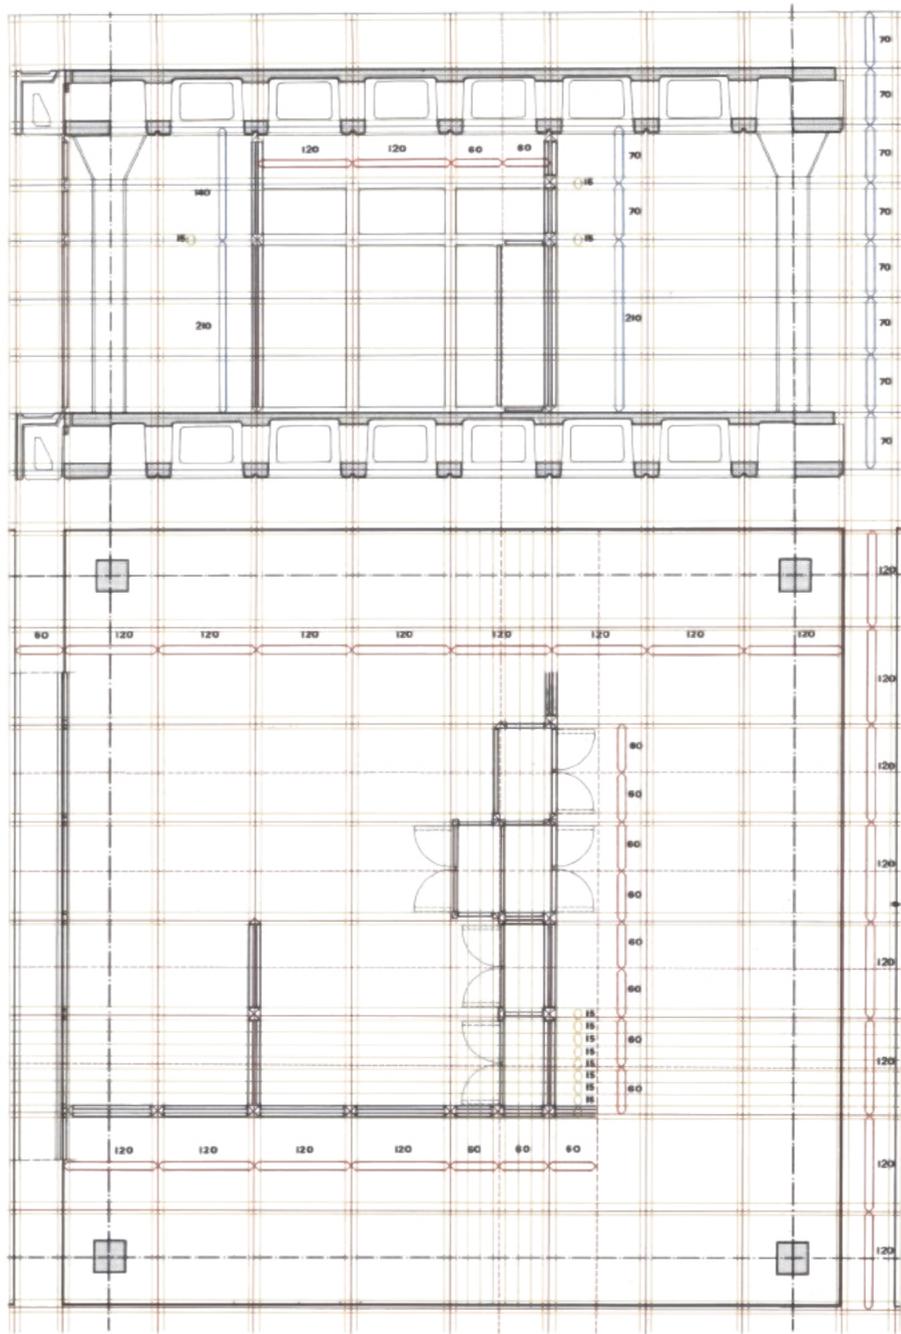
Bausystem, Konstruktionseinheit mit Bezugsraster und Ordnungsprinzipien.
